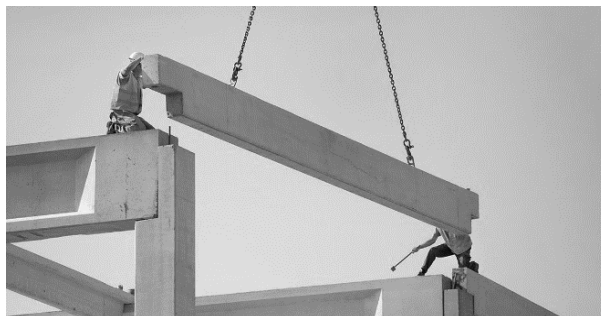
Viga de betão pré-fabricada, montagem em obra.
